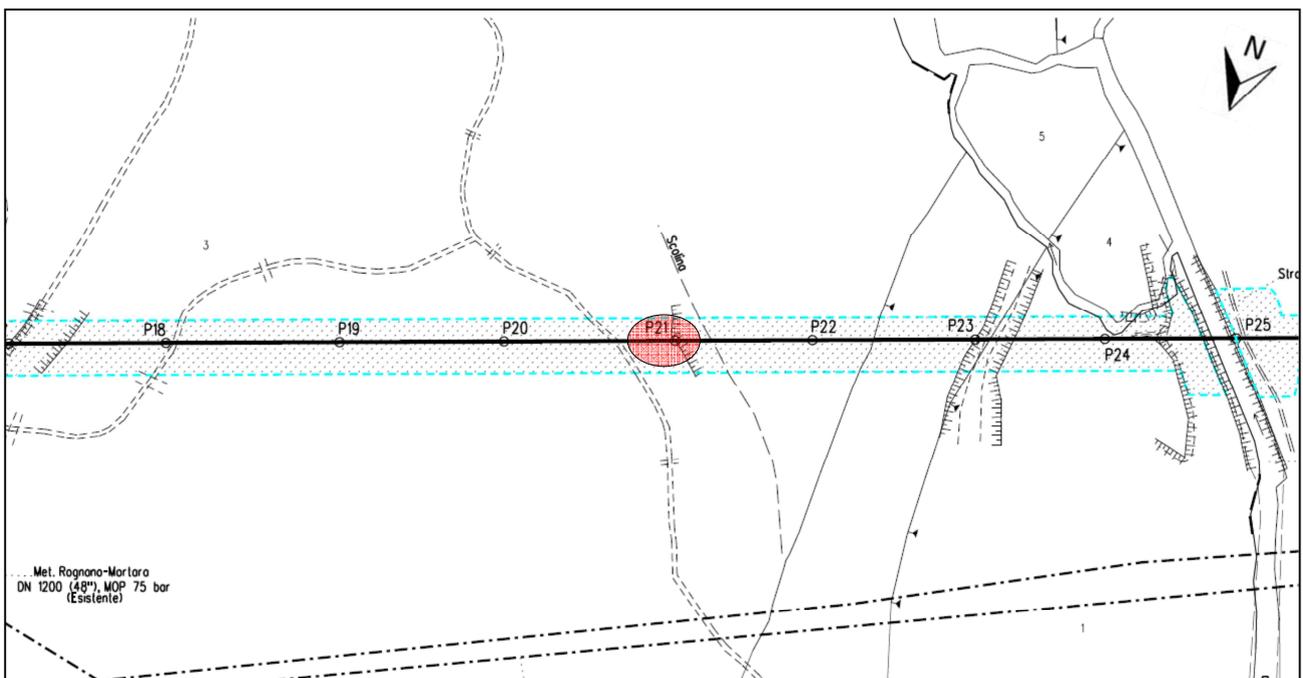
Localizzazione Area Test n. VEP 03 VG su planimetria catastale
